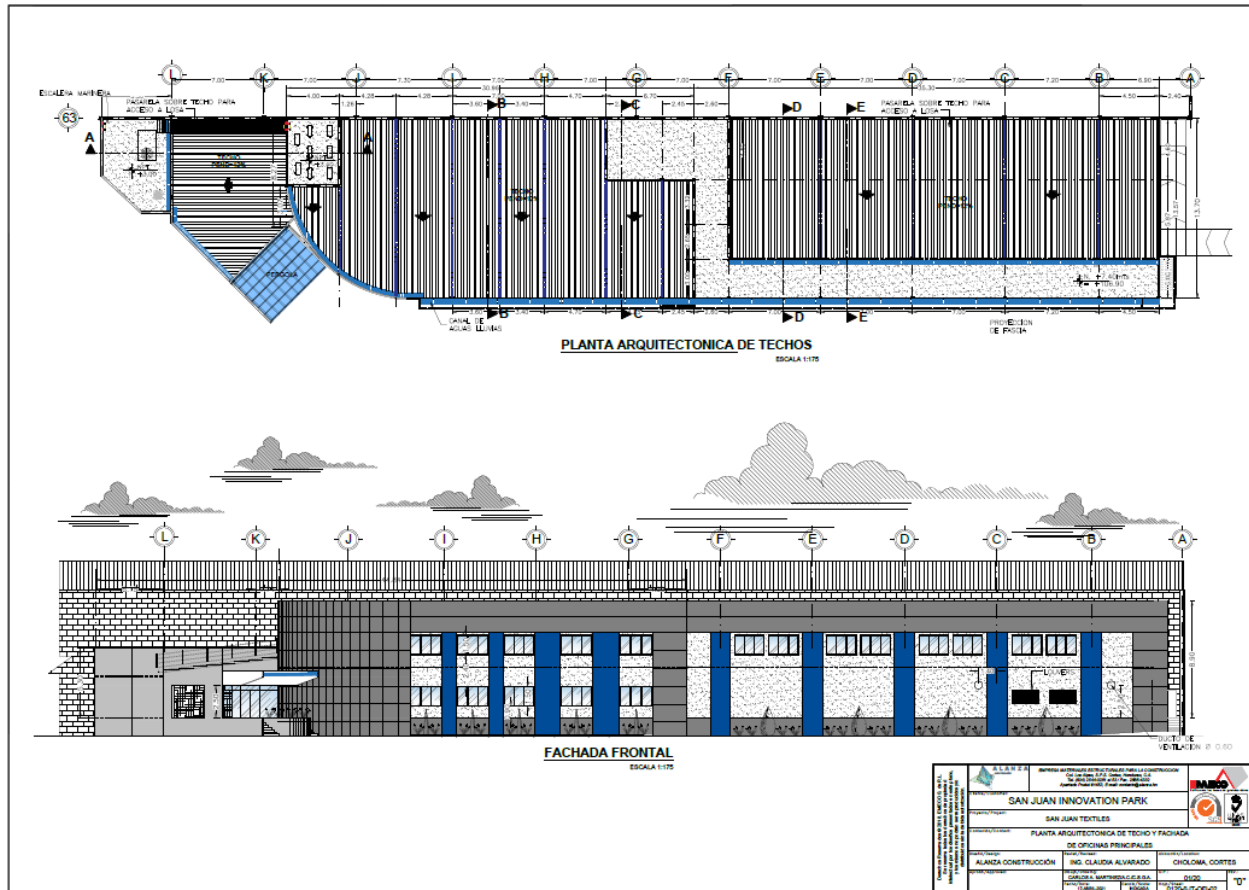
Fachada frontal y planta arquitectónica de techos en Oficinas Principales
